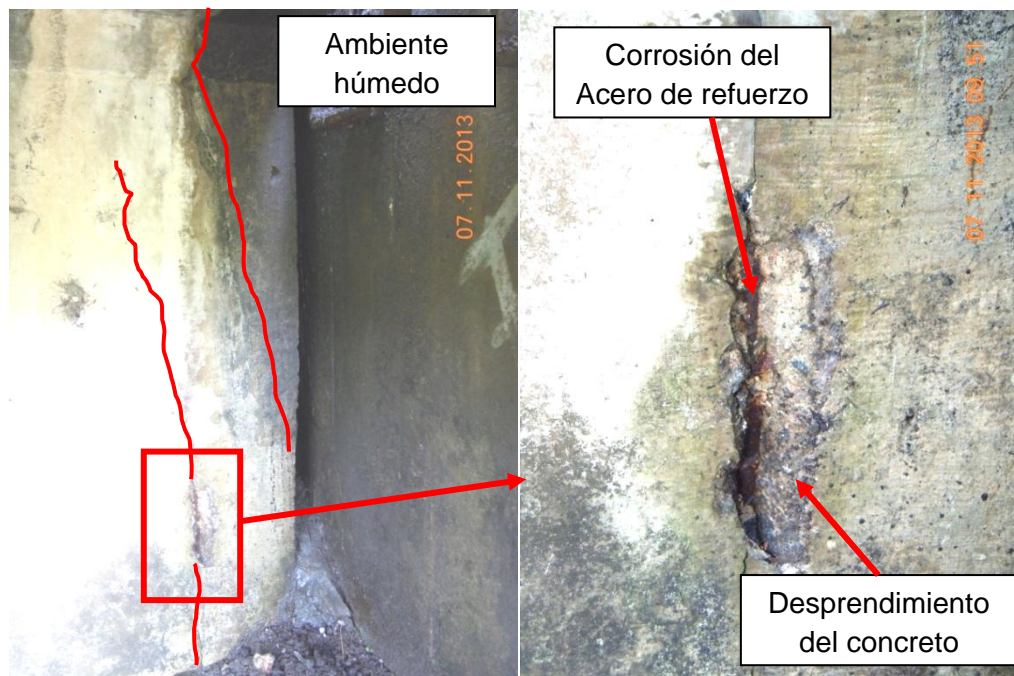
Agrietamiento y corrosión del acero de refuerzo en el alma de la viga externa-oeste sobre el bastión 2.
